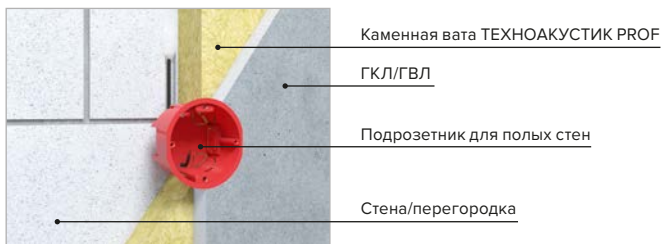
а. Вариант монтажа электропроводки в несущей стене и подрозетника без дополнительной защиты
